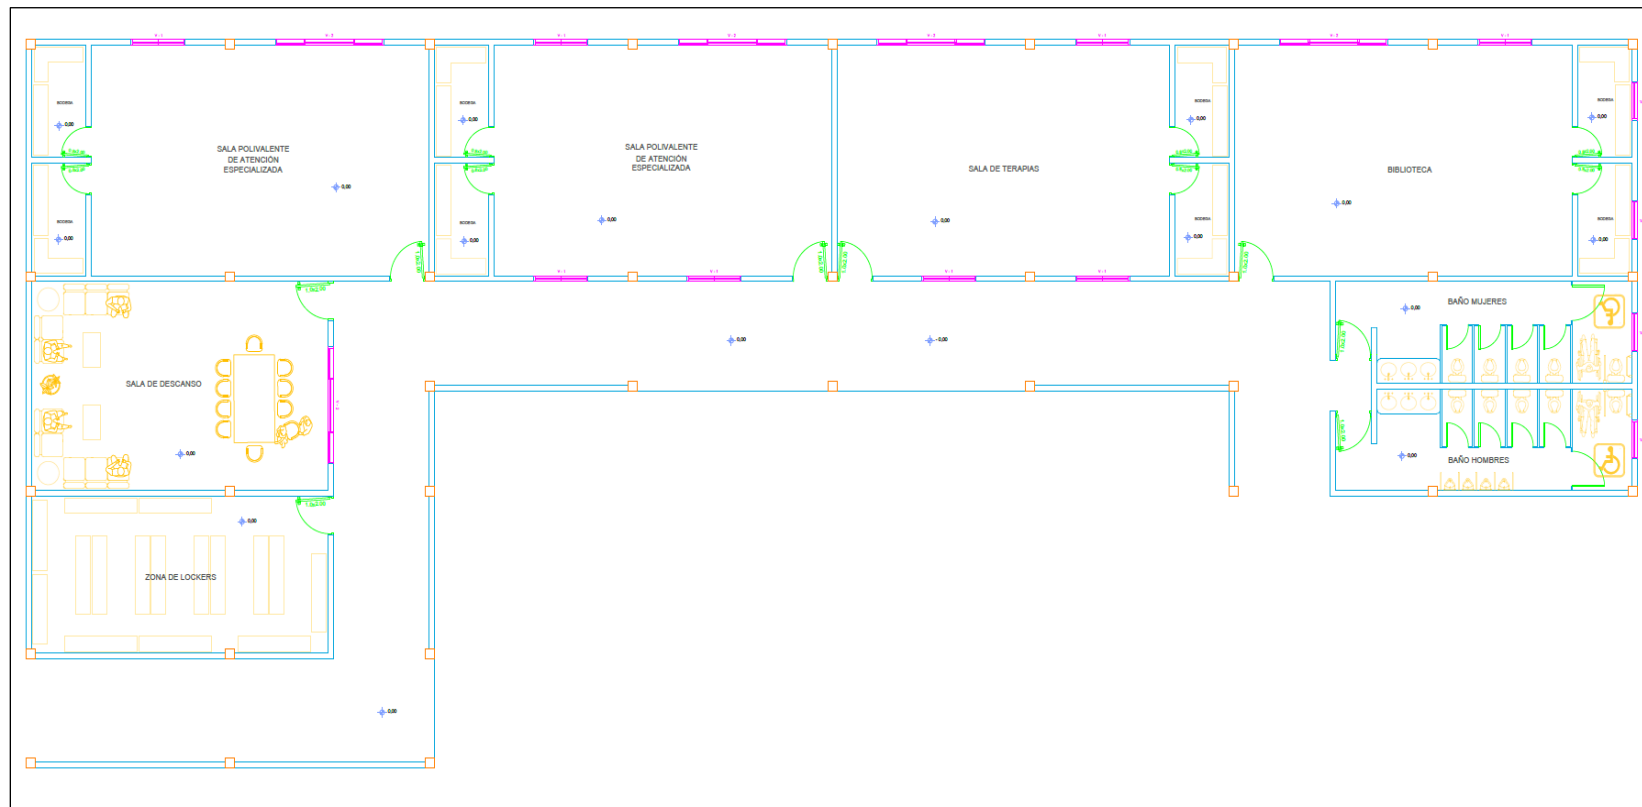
Diseño arquitectónico de la estructura 2 del Centro Vida.
